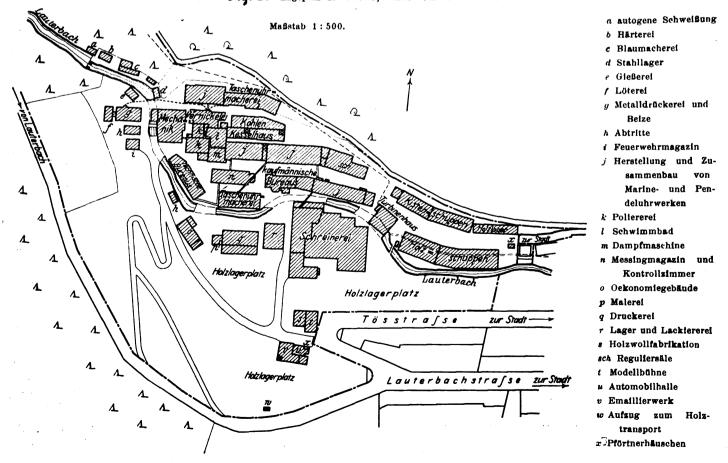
Lageplan der Fabrik, Stand vom Jahre 1912.
